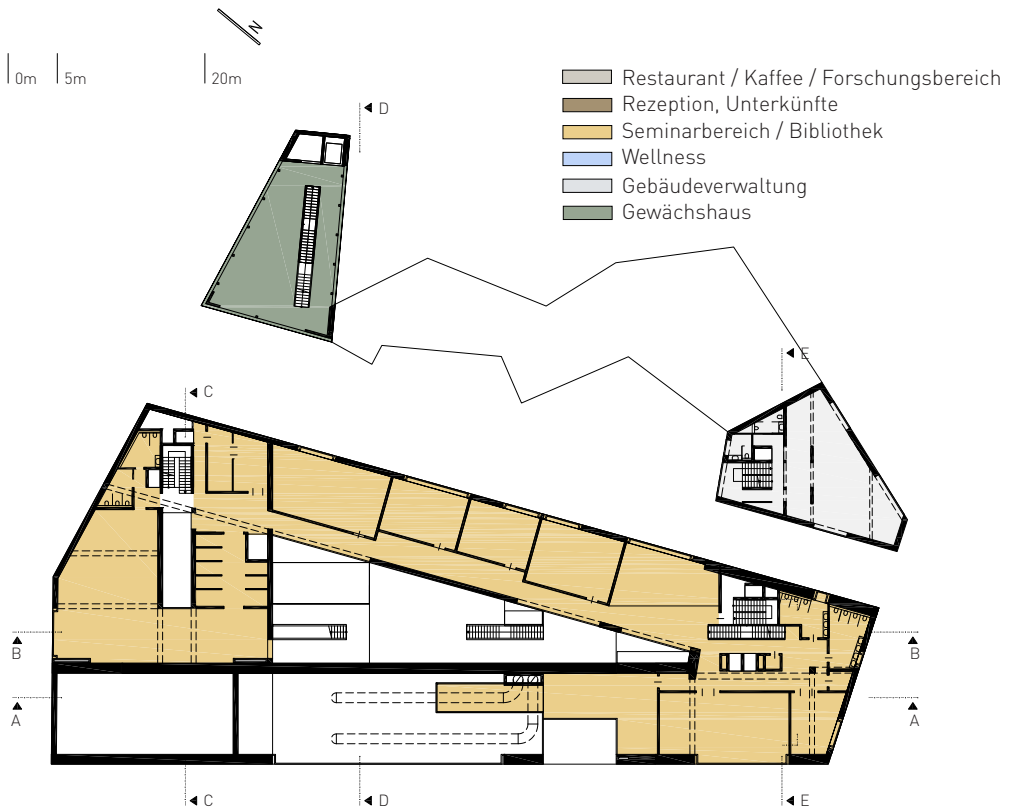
Grundriss Funktionen 2.OG +11,70m
